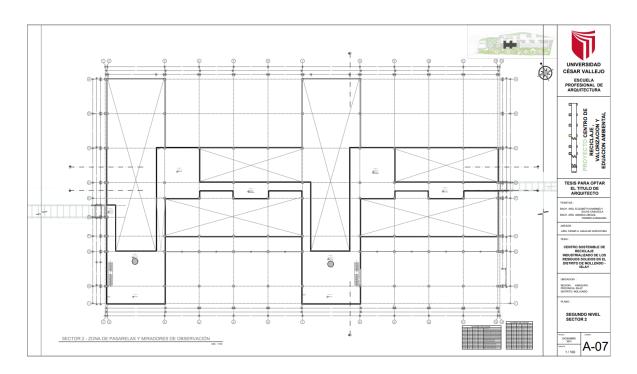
Planta de Distribución, Sector 2 – Segundo Nivel FUENTE: Elaboración Propia
